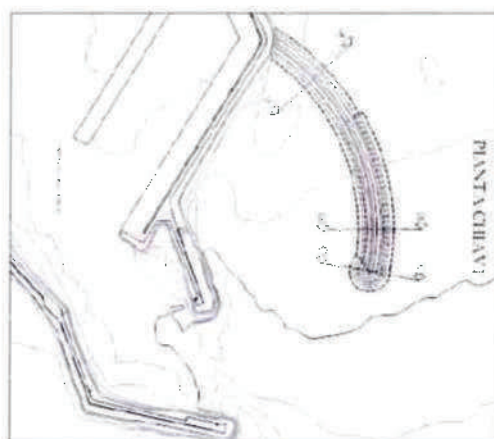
Planimetria della diga (ubicazione delle sezioni tipo riportate in fig 8)
